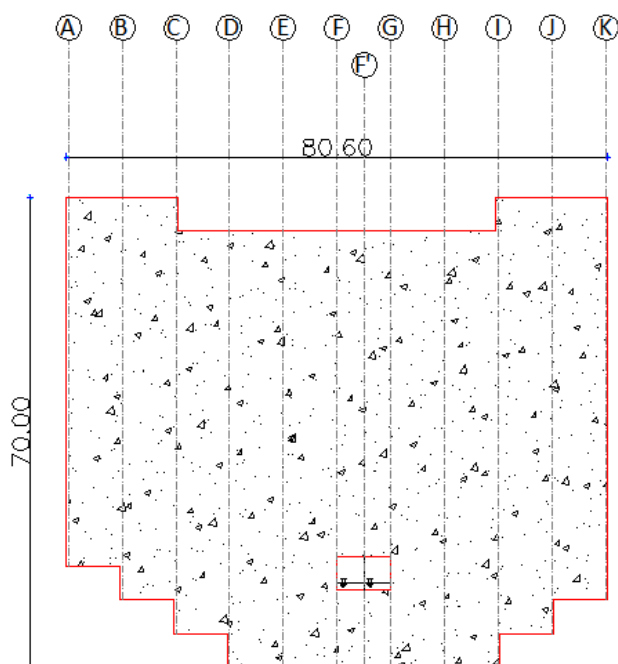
Corte de pantalla de hormigón. P. San Lorenzo
